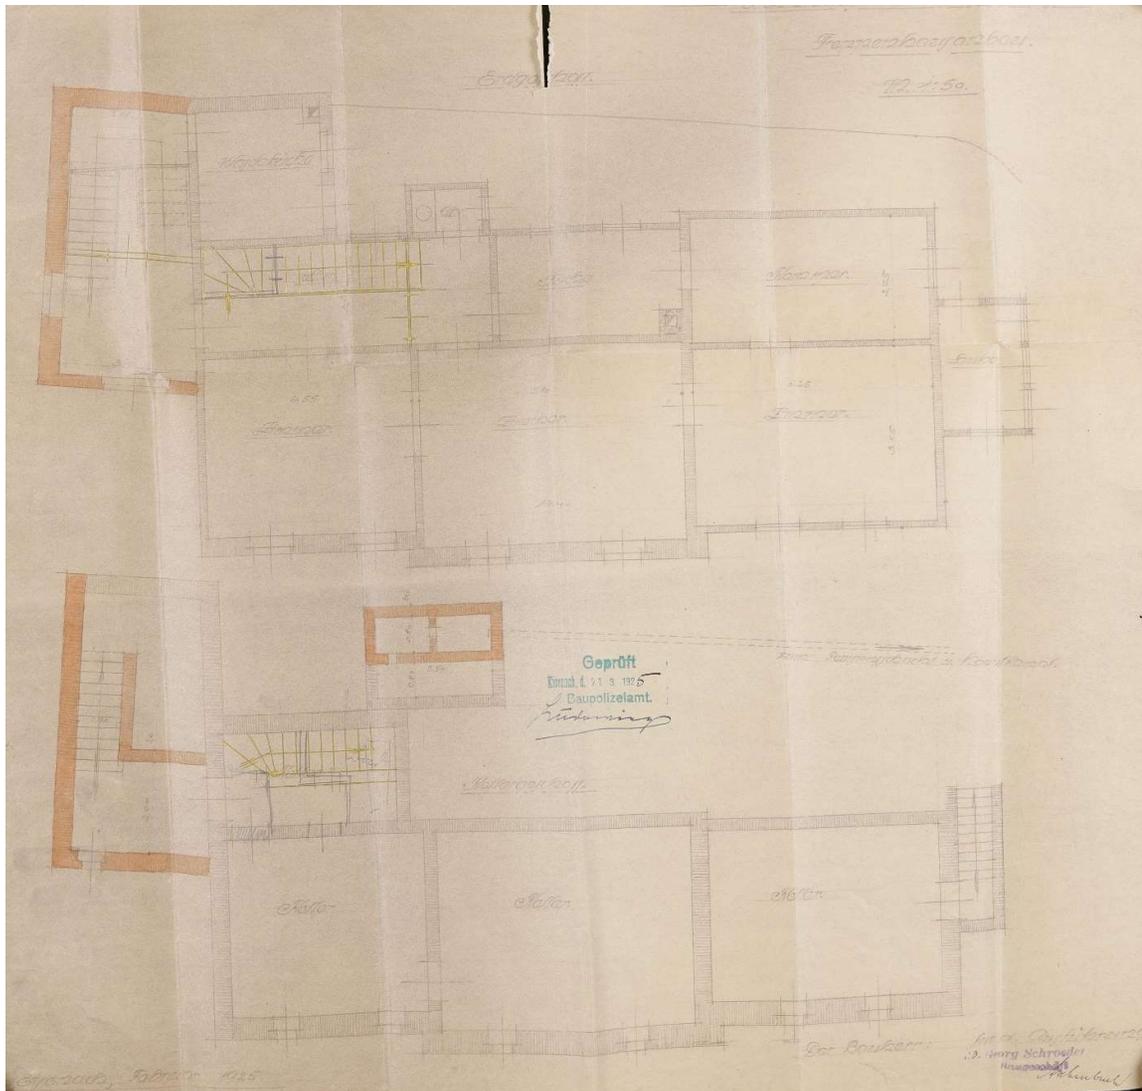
Diese Zeichnung zeigt das Erdgeschoss und das Kellergeschoss im Grundriss des Gärtereigebäudes anlässlich eines Treppenhausanbaus von 1925. Demnach ist davon auszugehen, dass dieses Gebäude zu der Zeit noch vorhanden und in Nutzung war. Quelle: Archiv und Bibliothek der EKM, Standort Eisenach, Bauarchiv ELKTh, 221/4.25, Eisenach Pflugensberg, Sammlung ohne Datum
